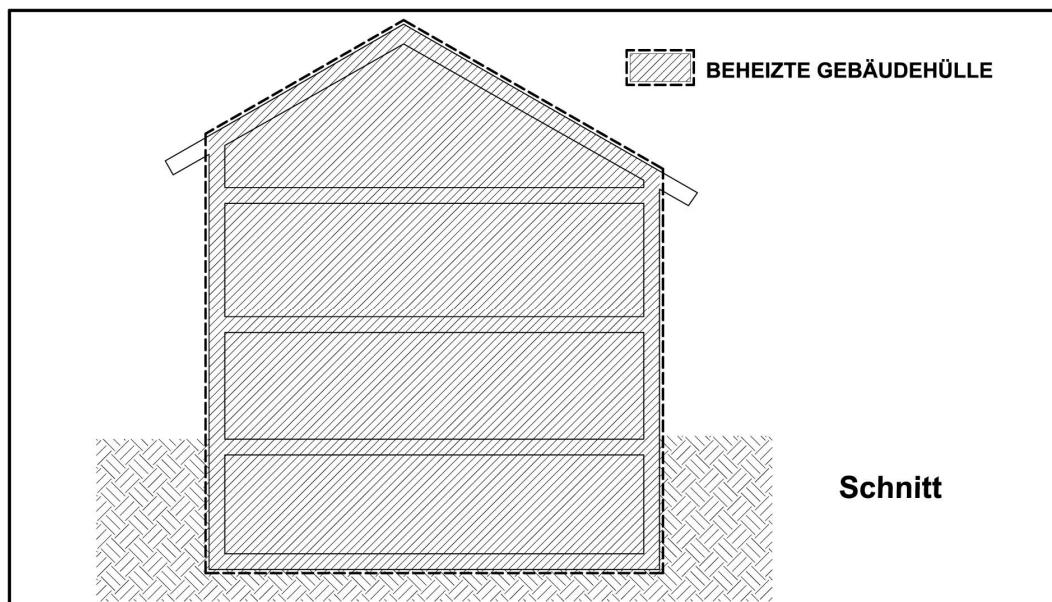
Gebäude mit beheiztem Dachgeschoss und Kellergeschoß
